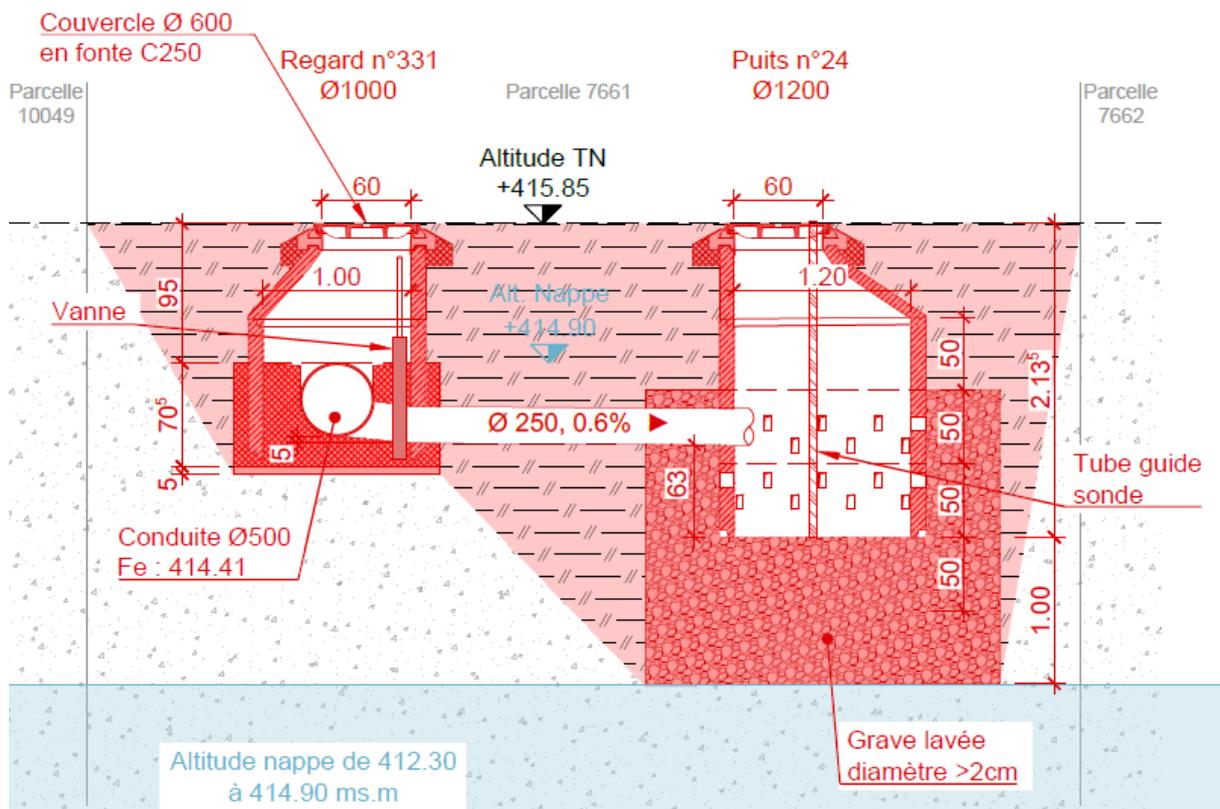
Coupe type d'un puits d'infiltration (exemple du puits n°24)
